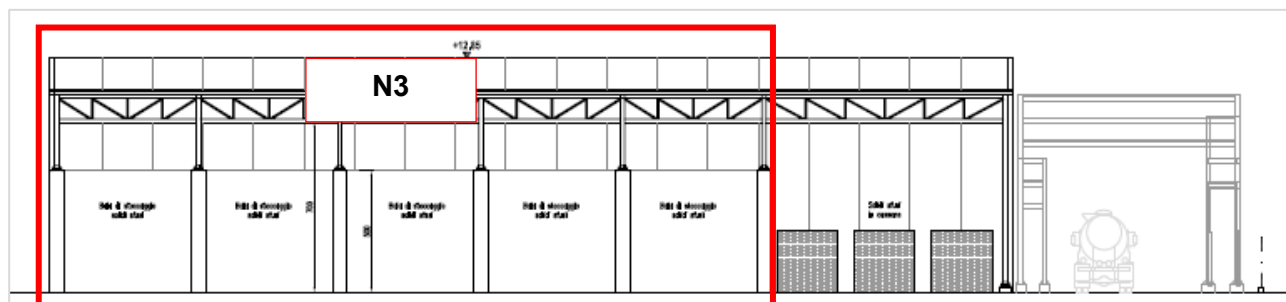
Prospetto EST (Stralcio elaborato CO 05 RA VA 01 D1 PL 69.00 - N3-N11 PROSPETTI E SEZIONI)
